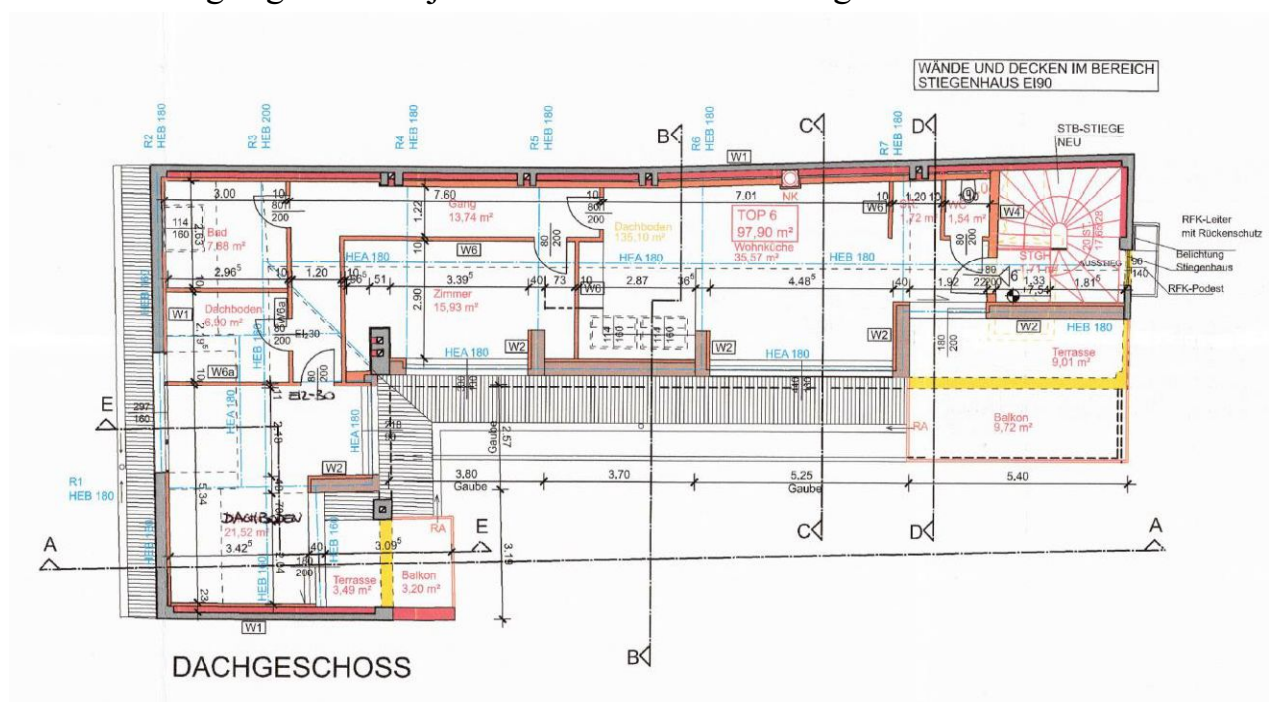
; Grundriss, o.M. aus der Einreichung mit Bewilligung vom 04.09.2024; Q: Bauakt
